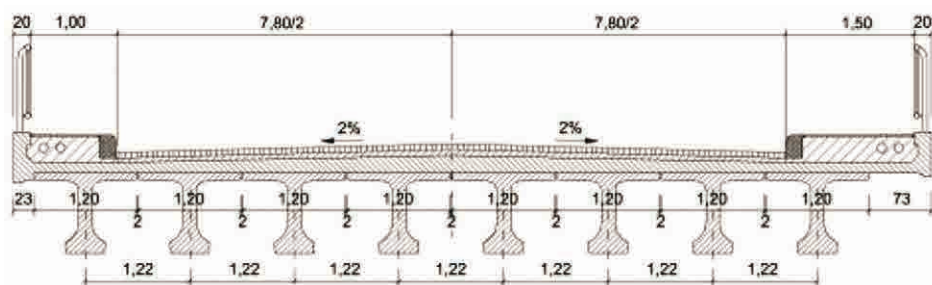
Secțiune transversală prin suprastructura unui pod pe grinzi prefabricate tip T cu armătură preîntinsă și placă de suprabetonare, $L_{grinda}=18.00m$, cu trotuar din beton armat monolit
